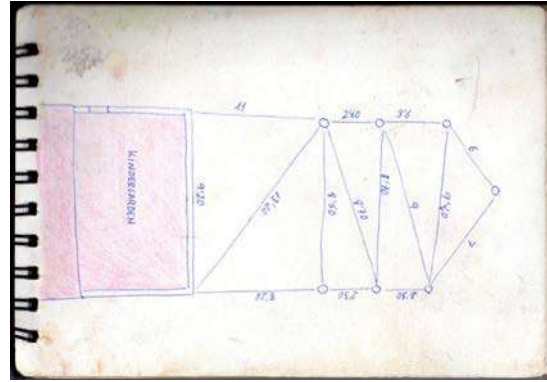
Boceto dimensiones zona parque en kindergarten. Elaboración propia
